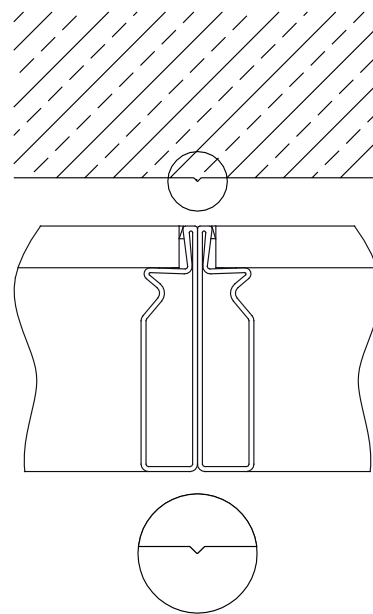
Ebene Betonoberfläche, da keine überstehenden Profilnasen.
